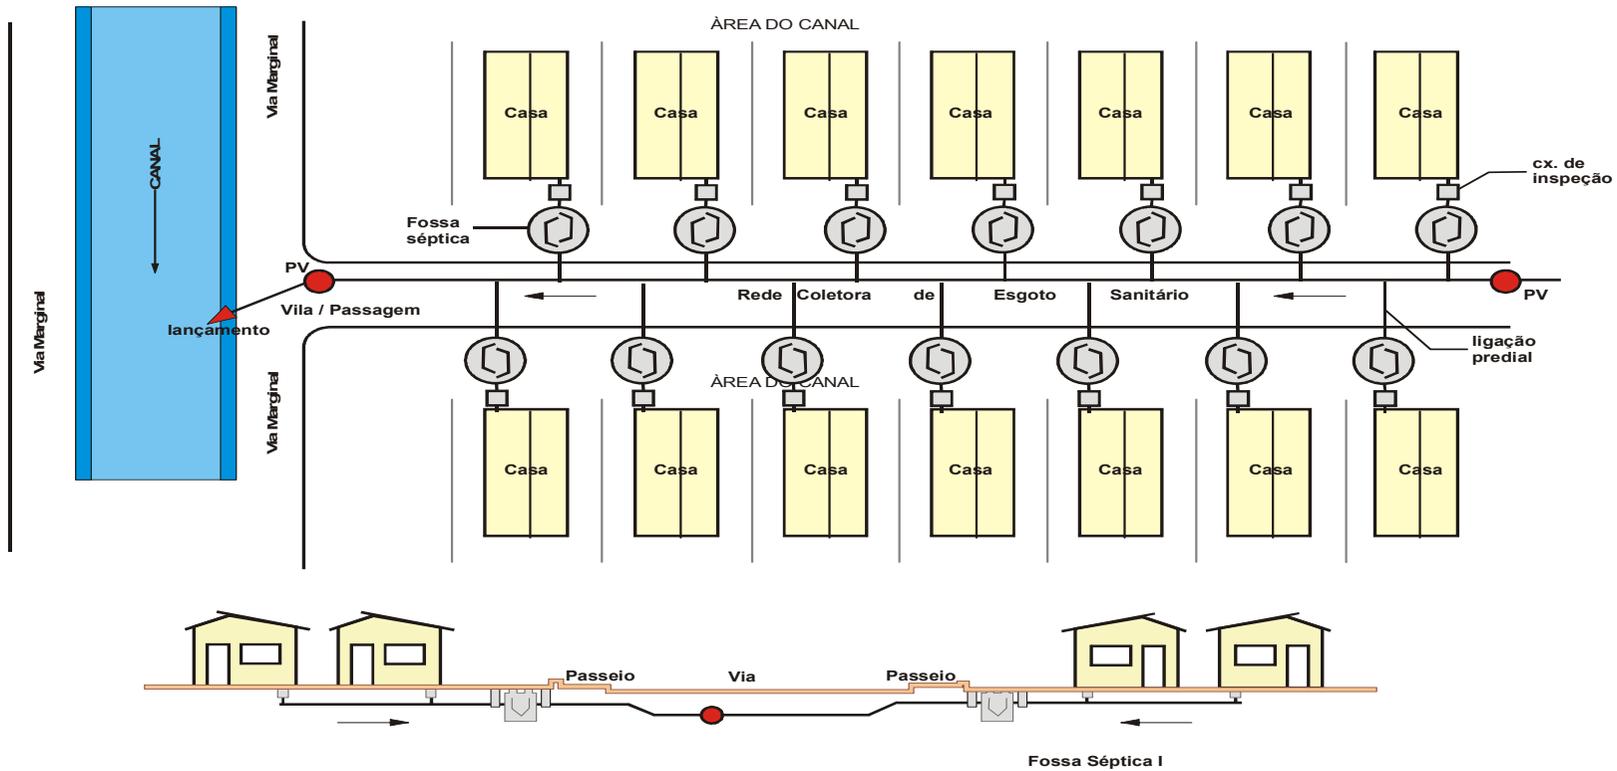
Planta baixa de sistema com tratamento individual (sem escala)
